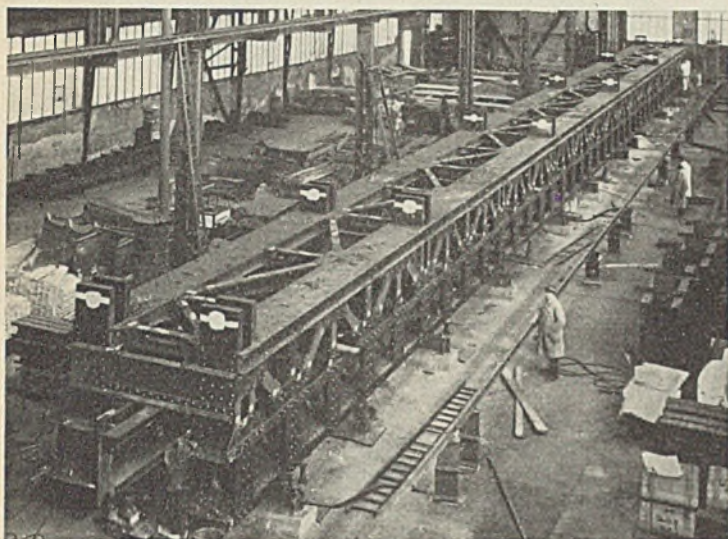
Mutterbackensäulengerüst im Werk zusammengebaut.
